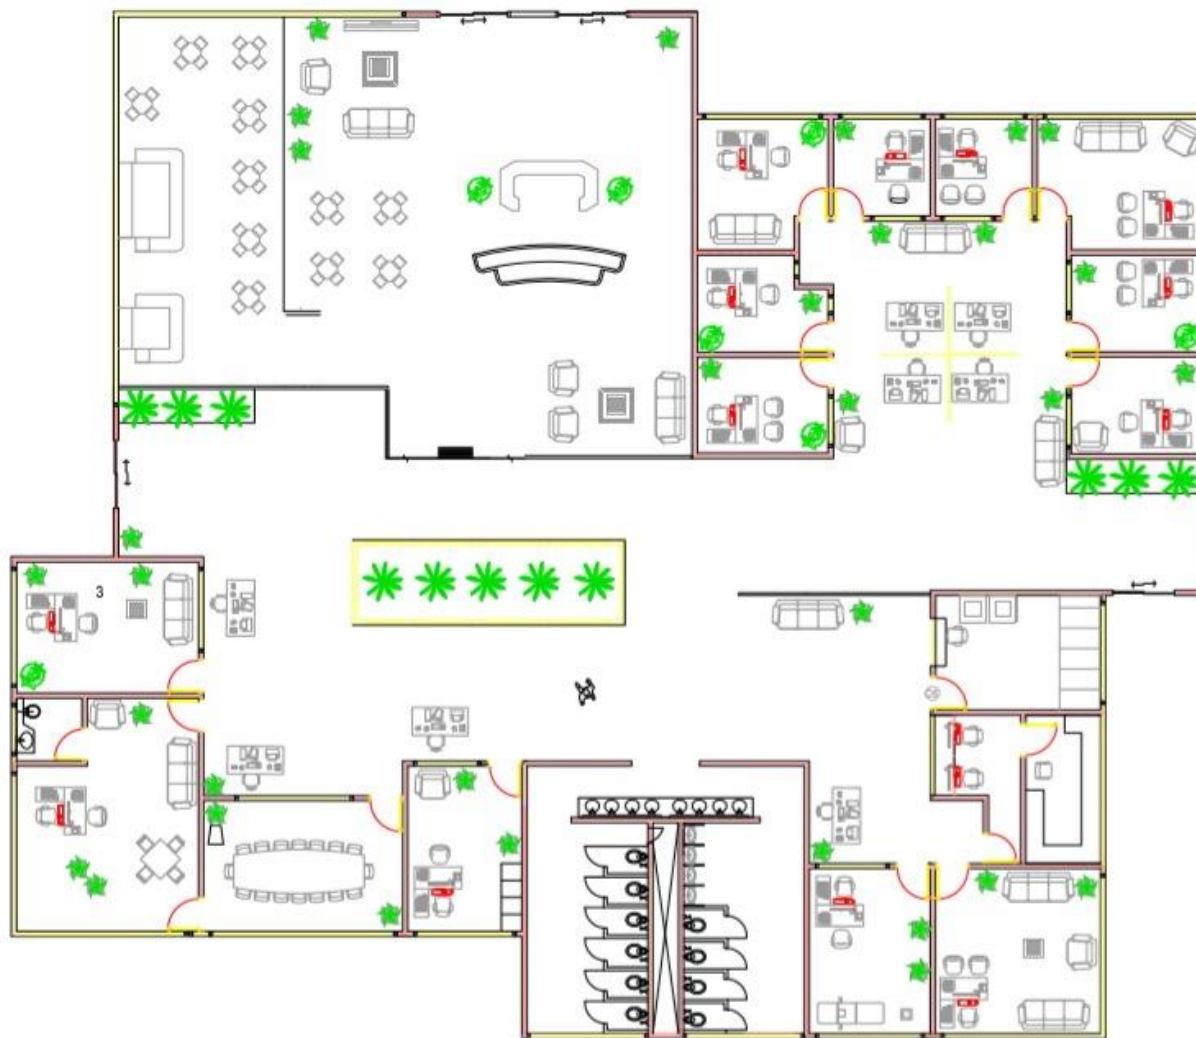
Aulas (2). Planta arquitectónica.
